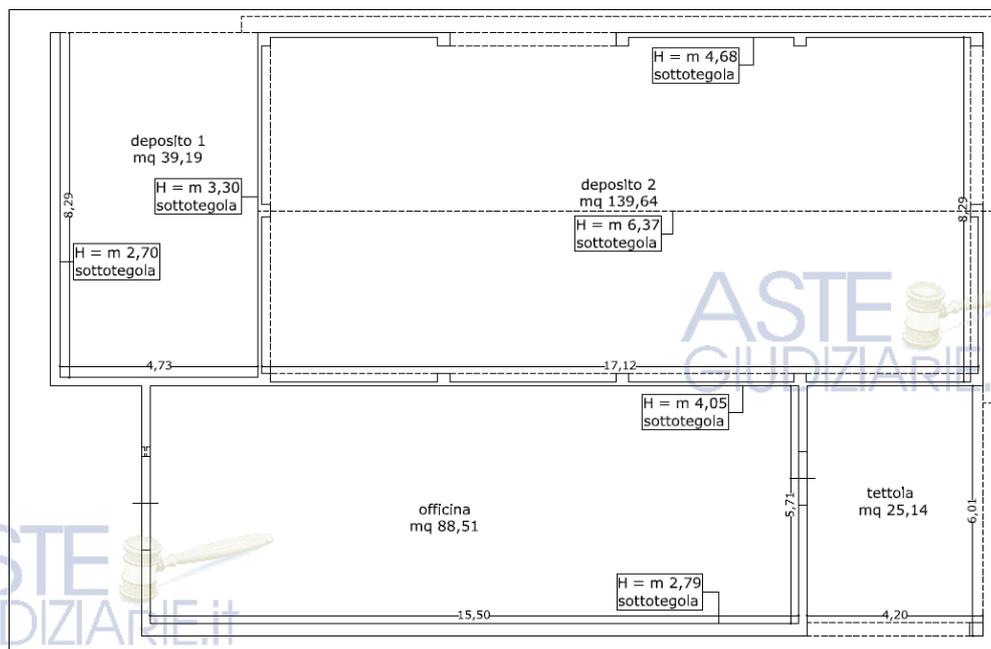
LOTTO 6- Deposito 1, p. Ila 28
